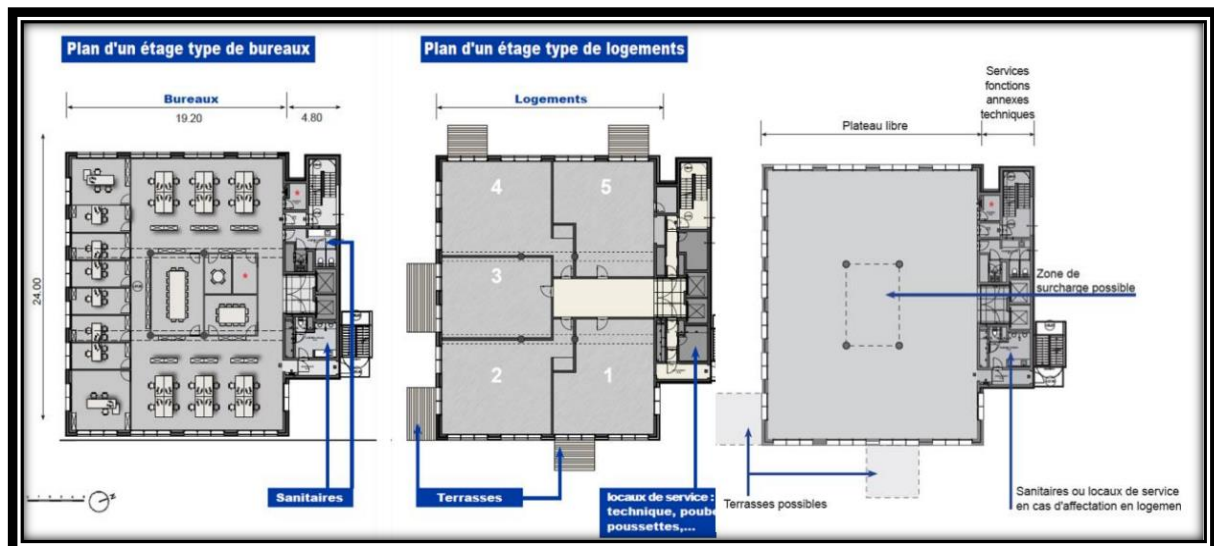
plan d'un étage dans le cas de bureaux et logements ; source : ArtBuild. (s. d.). Art Build. Consulté le 25 mai 2021, à l'adresse <https://www.artbuild.com/>
